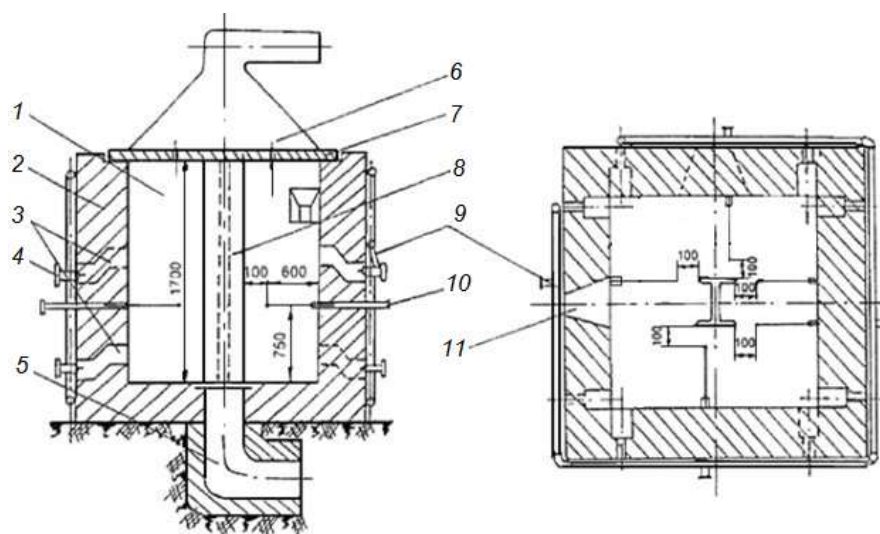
Проект МГС, приложение А - Установка для огневых испытаний малогабаритных образцов стержневых конструкций
